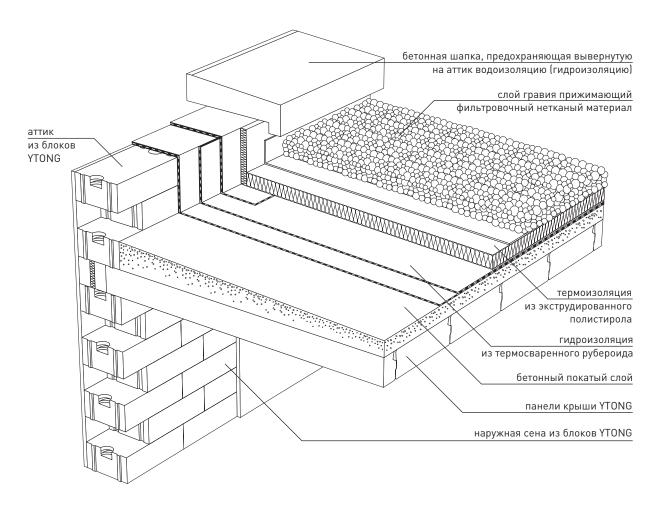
Инверсионная кровля с использованием плит покрытия YTONG - общий вид
